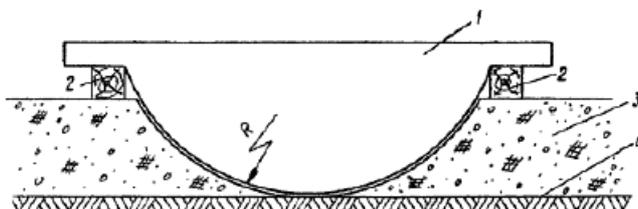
Схема установки шаблона для вырезки грунтового ложа в основании:
